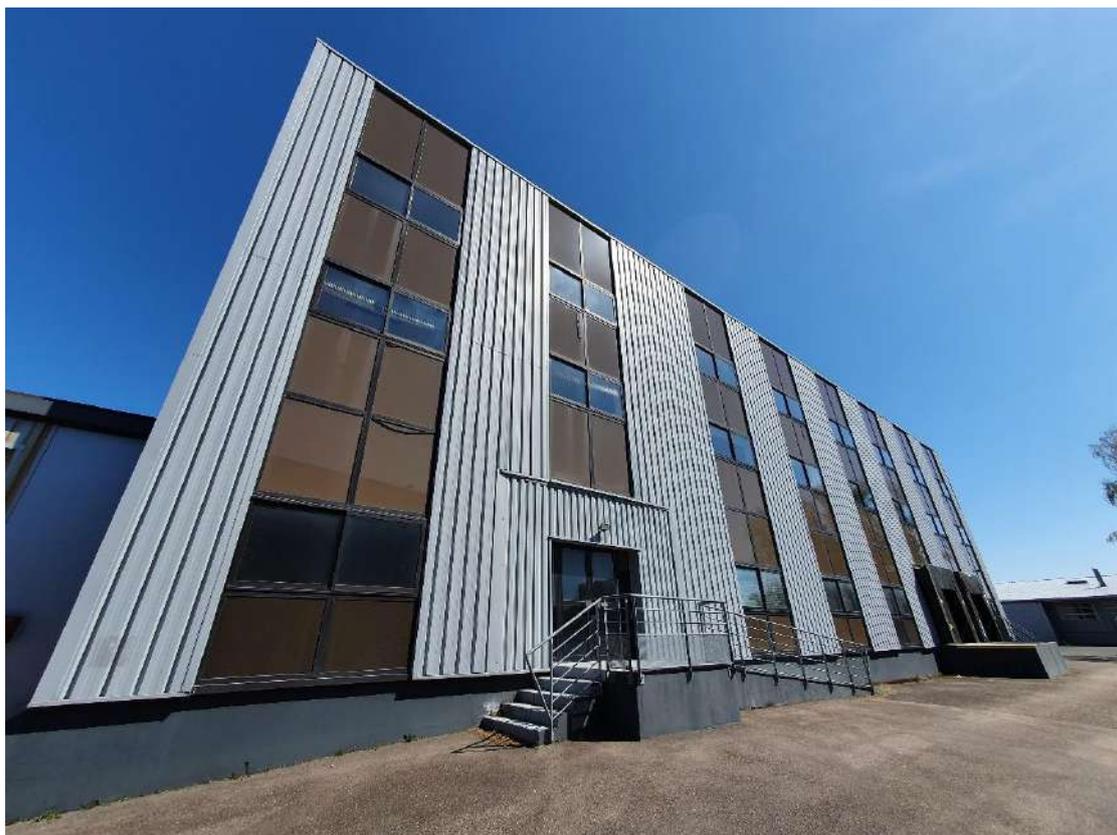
Lot 7 / Face OUEST / Accès piéton et rampe PMR
